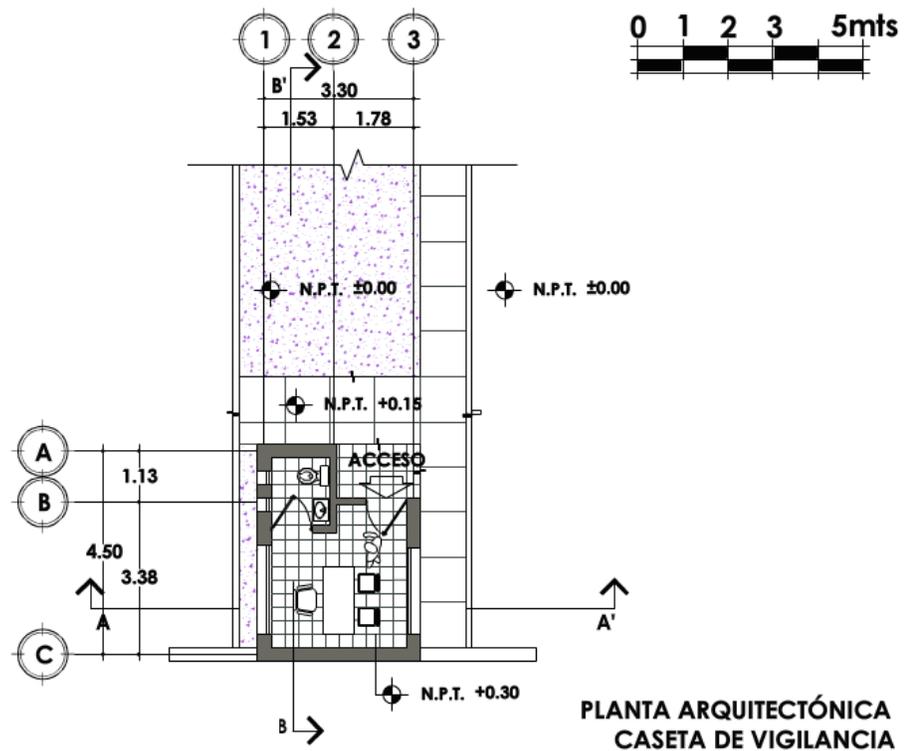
Planta arquitectónica, caseta de vigilancia
